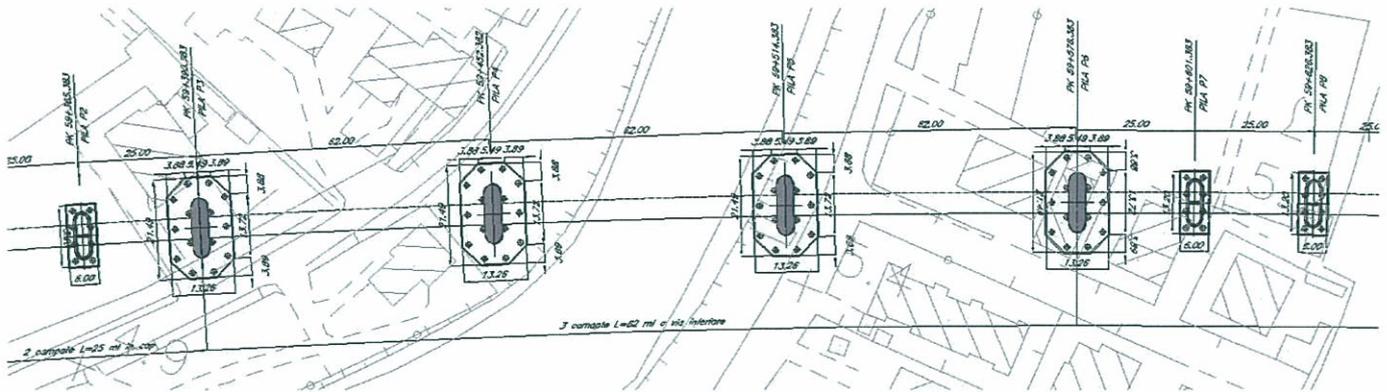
Pianta fondazioni in corrispondenza dell'attraversamento del fiume Lemene.
